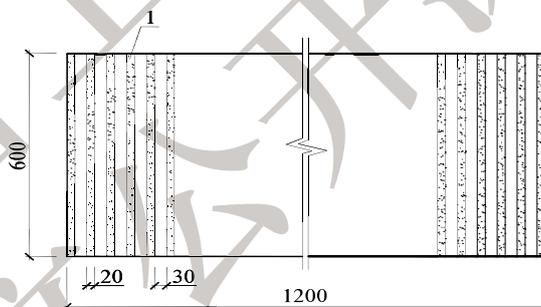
条粘法示意（尺寸单位：mm）
